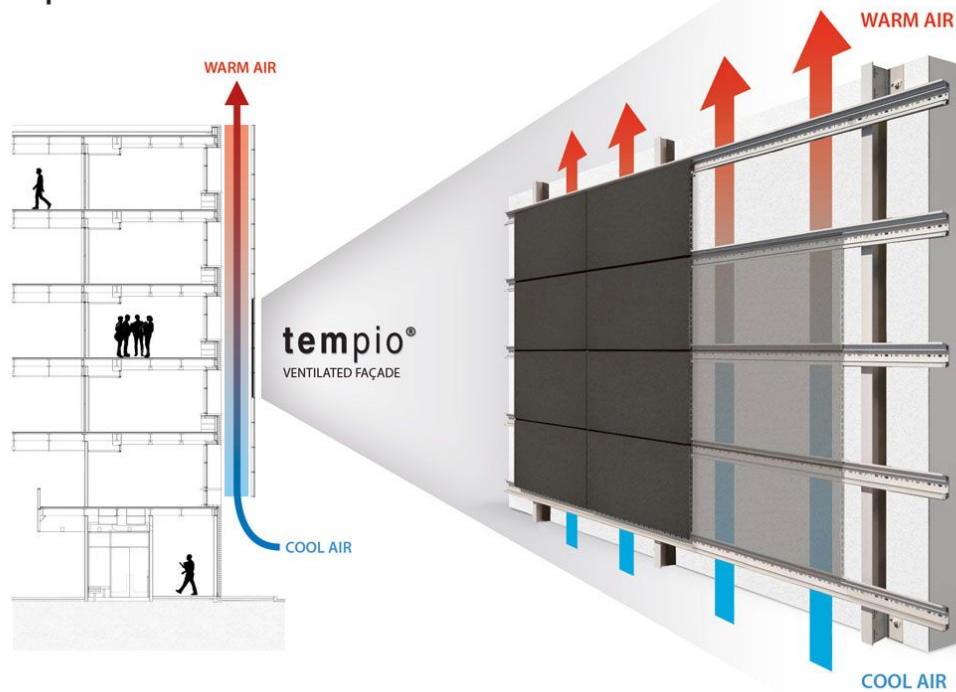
Sección fachada ventilada, efecto chimenea en invierno (Fuente:tempio)
